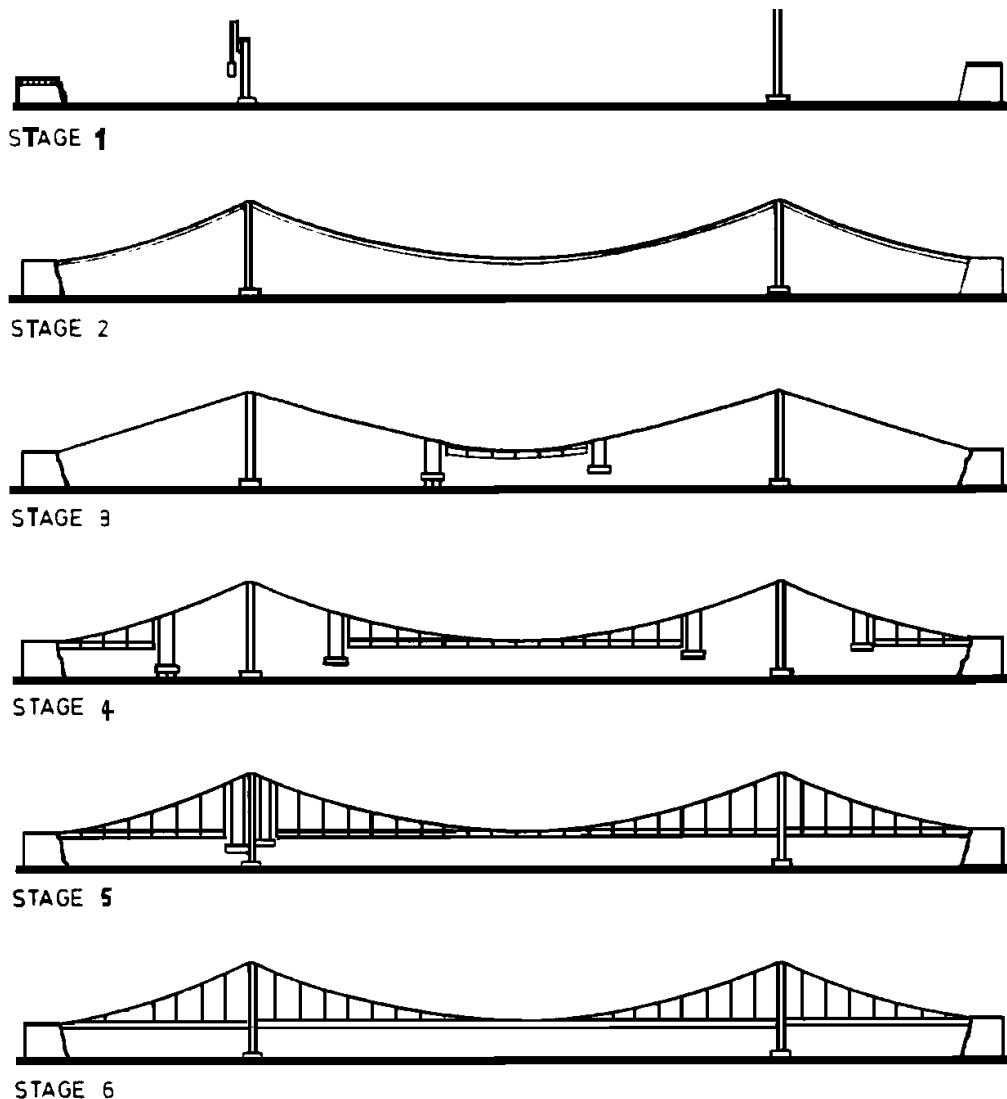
Estágios de construção de uma ponte pênsil (Gimsing, 1983).
